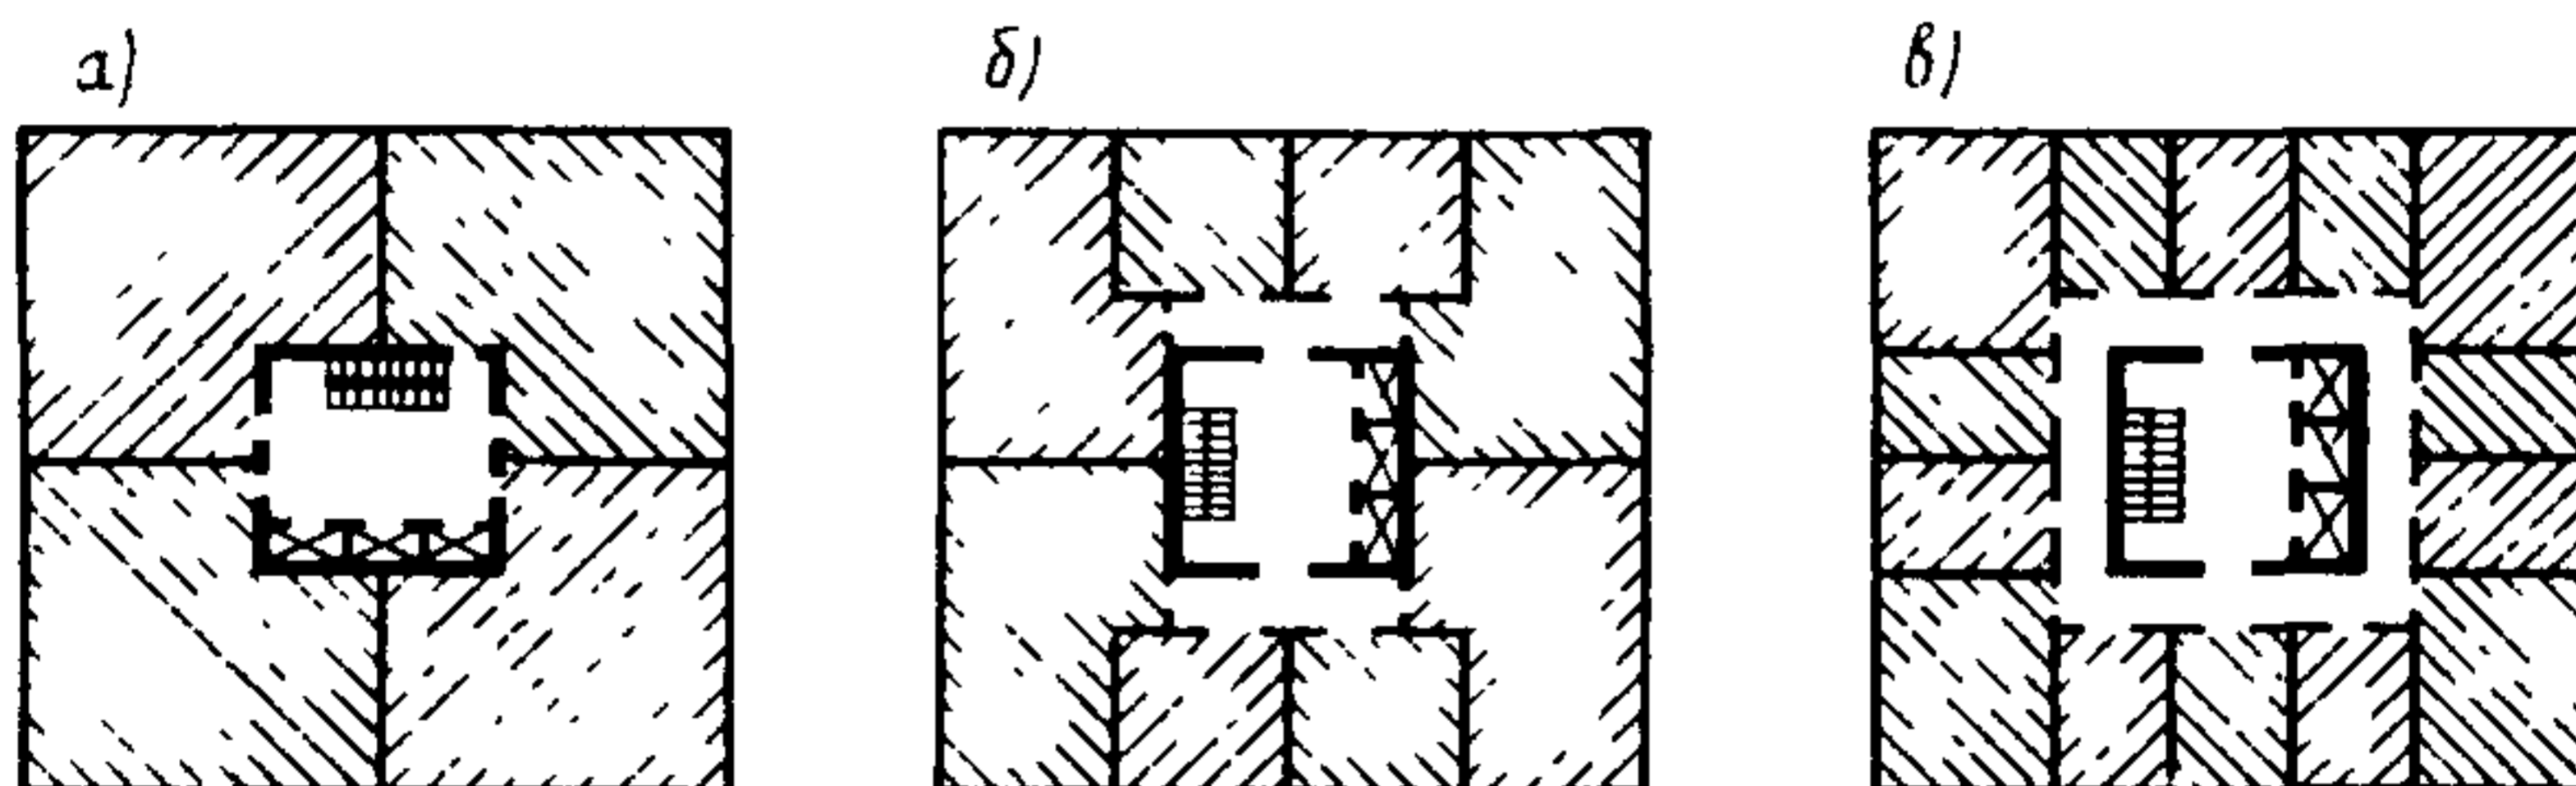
Планировочные решения башенных зданий с монолитными ядрами жесткости (квартиры выделены штриховкой)
